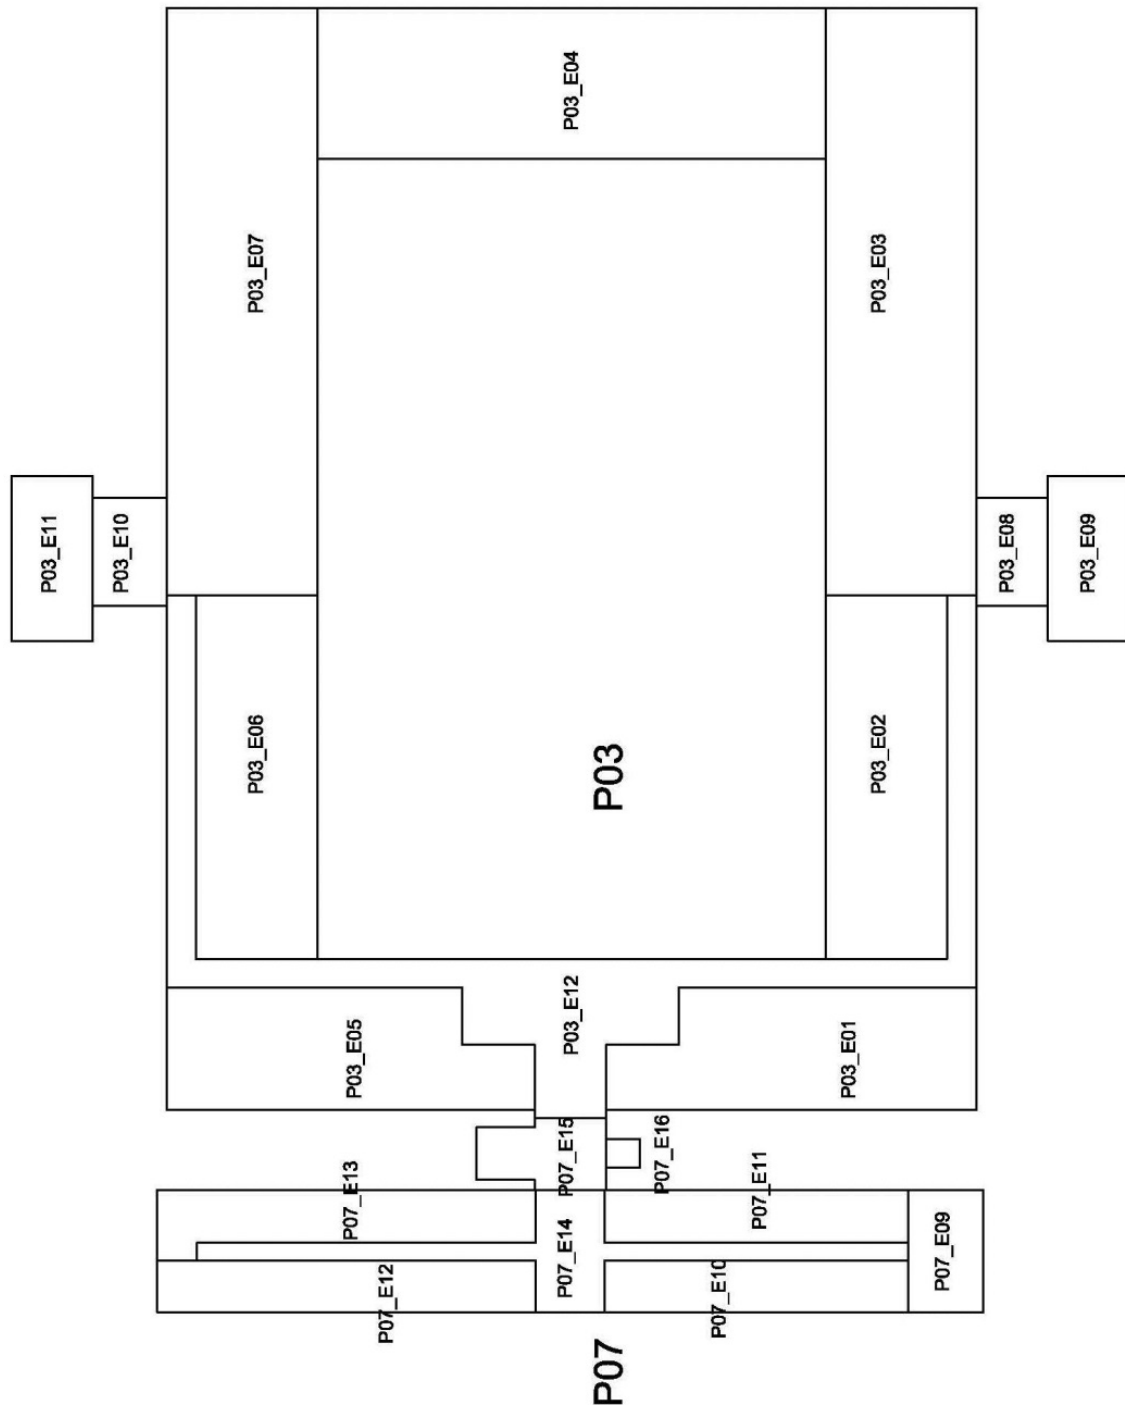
Distribución en planta de los espacios de las plantas P03 y P07.
